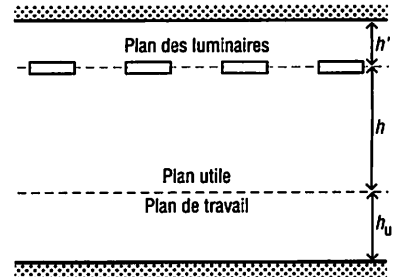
Disposition des luminaires dans le sens de la hauteur.
